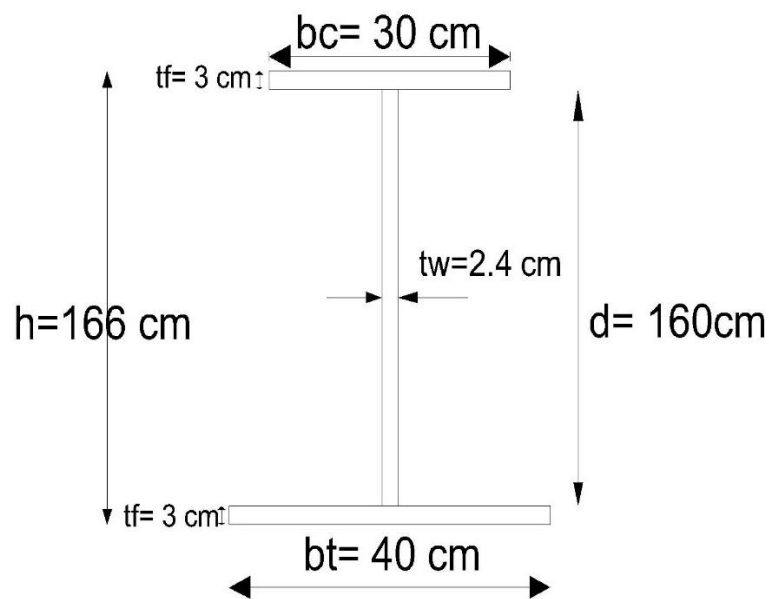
33: Dimensionamiento adoptado por la viga metálica armada (Fuente: Elaboración Propia)
